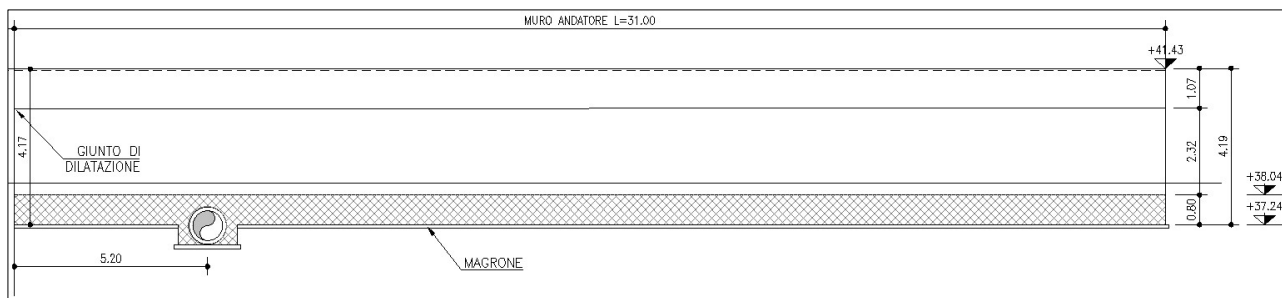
Prospetto del muro andatore lato Rimini – Allargamento Sud
